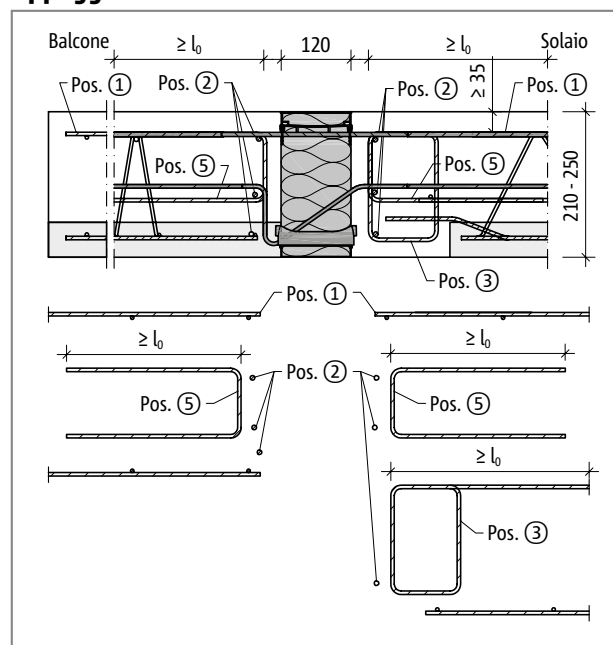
Schöck Isokorb® tipo KFXT: armatura in opera con spessore del balcone h = 210 - 250 mm
